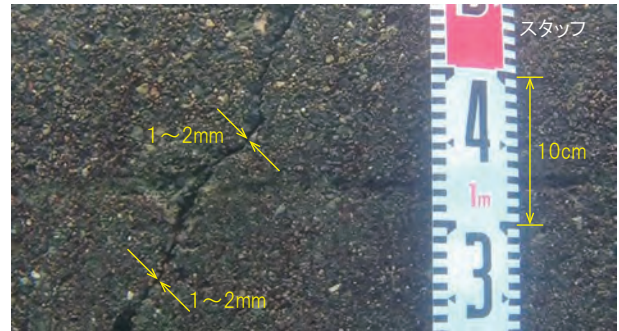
ひび割れ(上)と開孔(下)のサイズ計測
